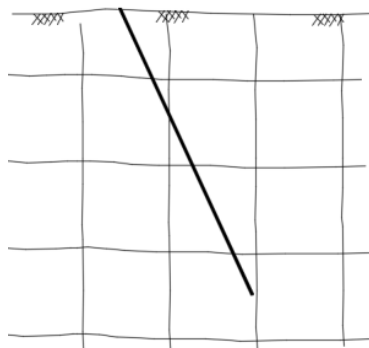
Perforación intersectando discontinuidades verticales y horizontales. Adaptado de "Construction and design of cement grouting" de Houlsby, A.C. (1990).
